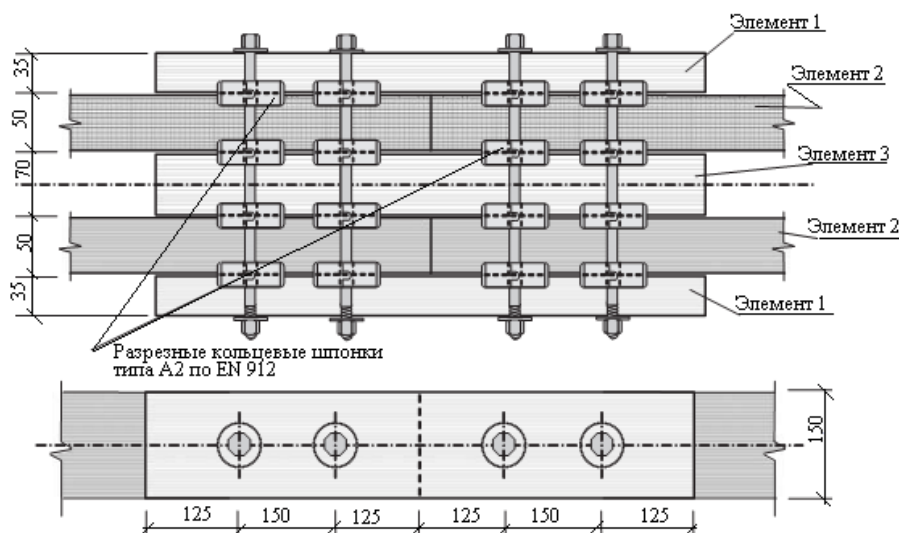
Схема стыковочного узла нижнего пояса фермы
